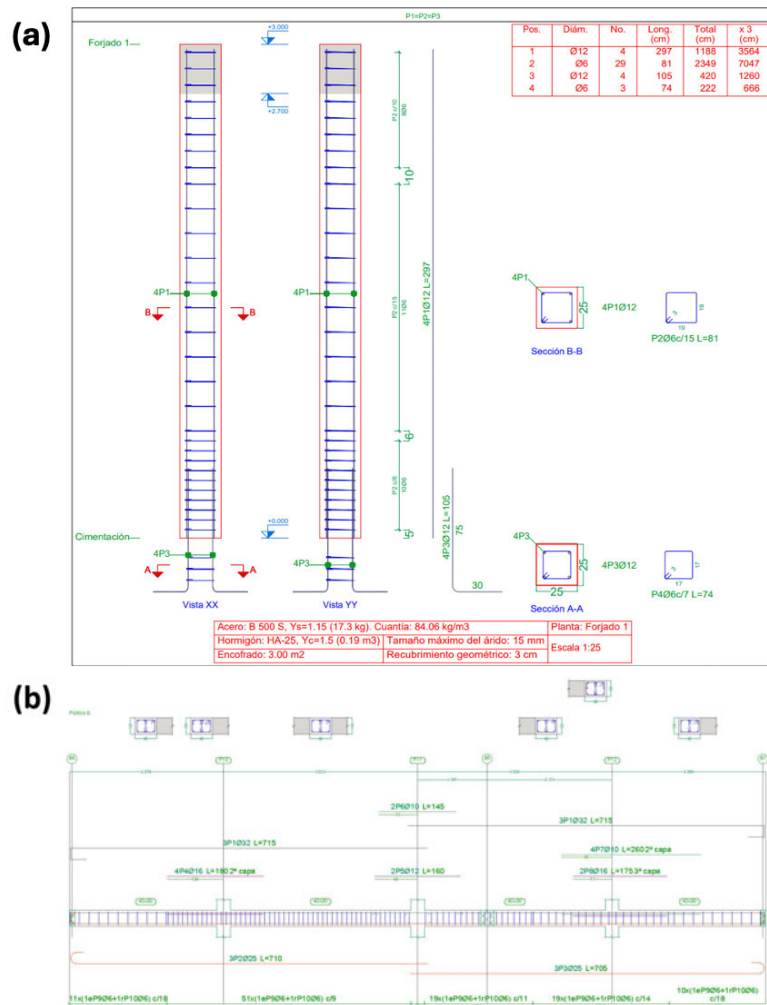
Armados calculados en CYPECAD: (a) pilar; (b) crujía.
